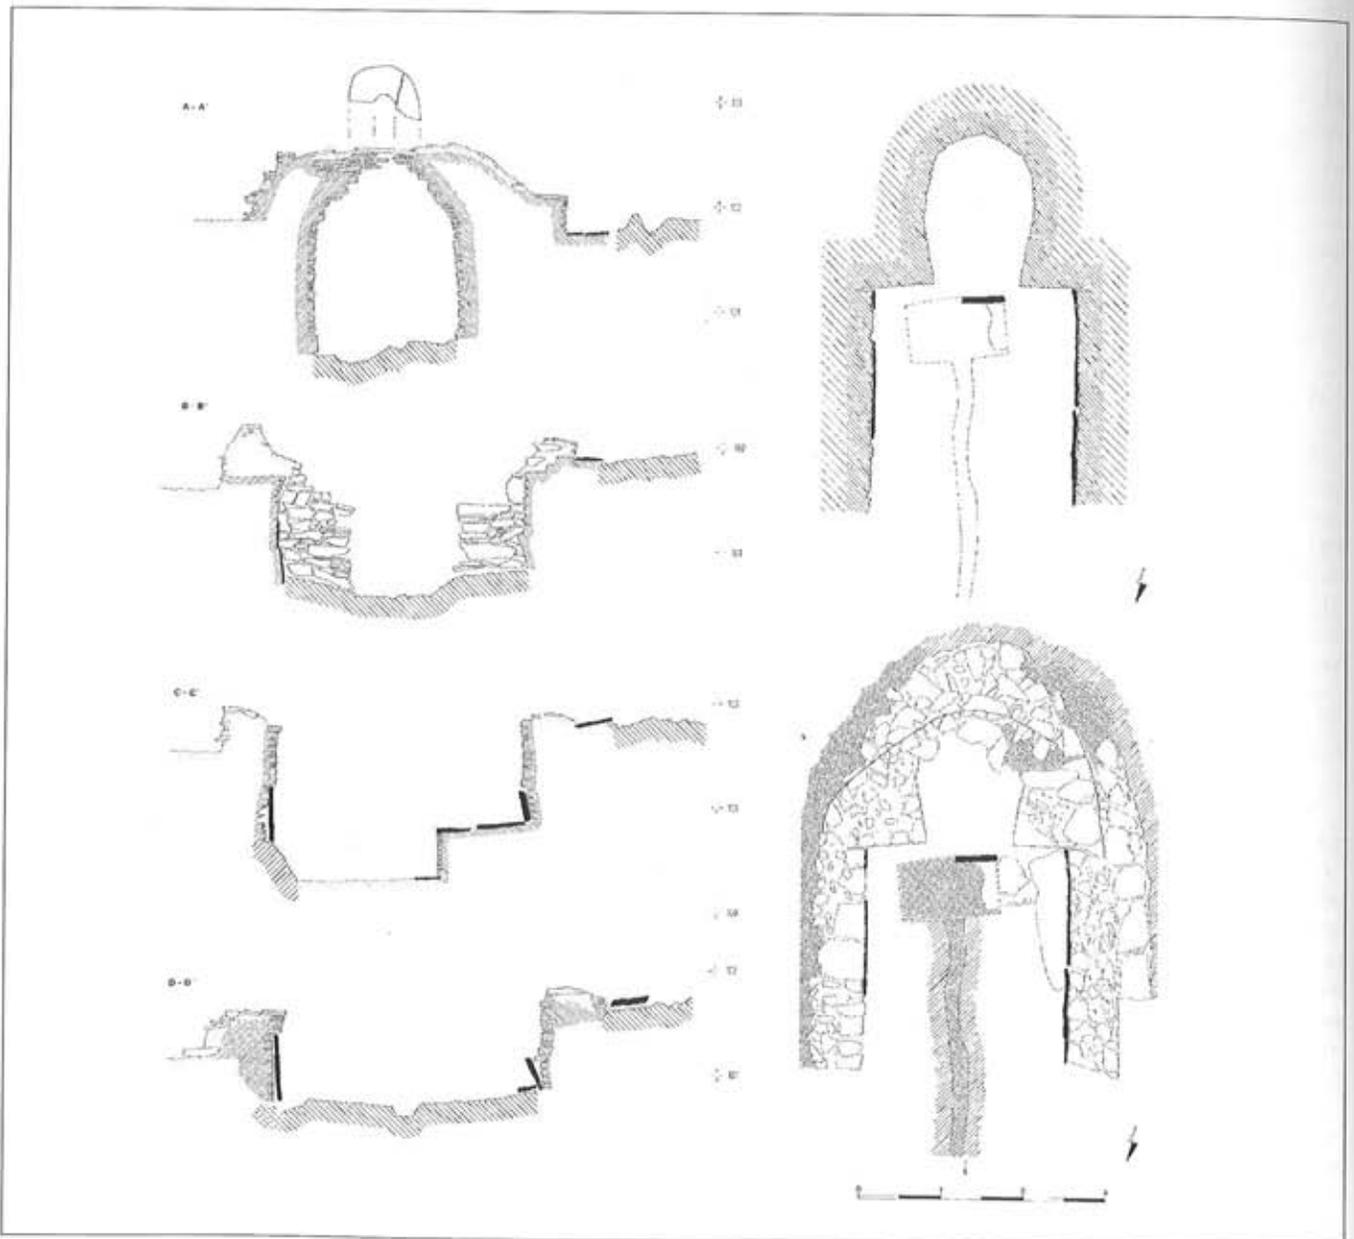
Pencia 1. Planta y secciones del edificio termal primitivo.
